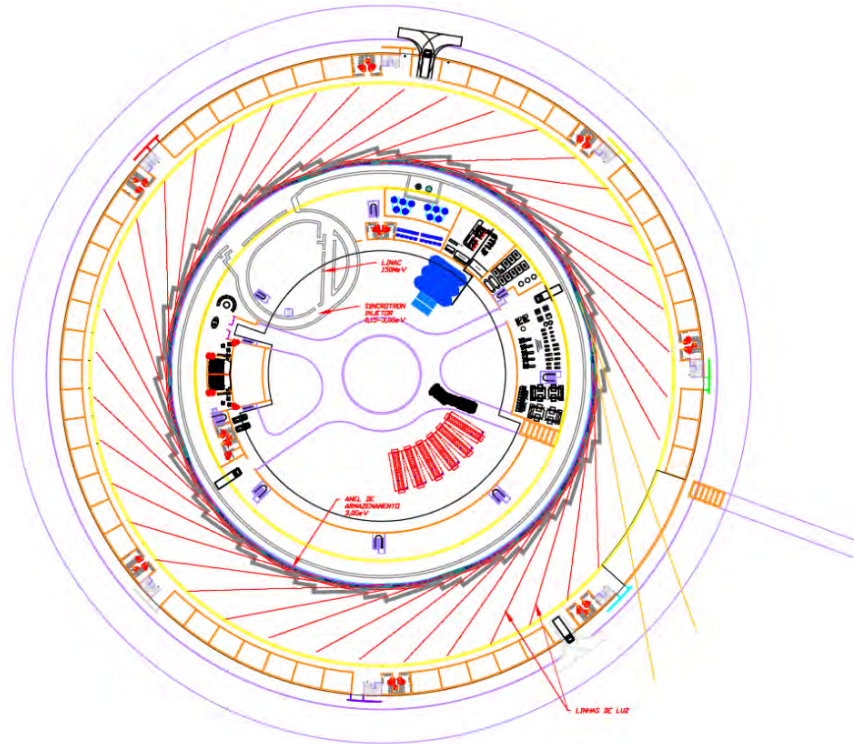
Planta baixa do projeto arquitetônico básico de Sirius
